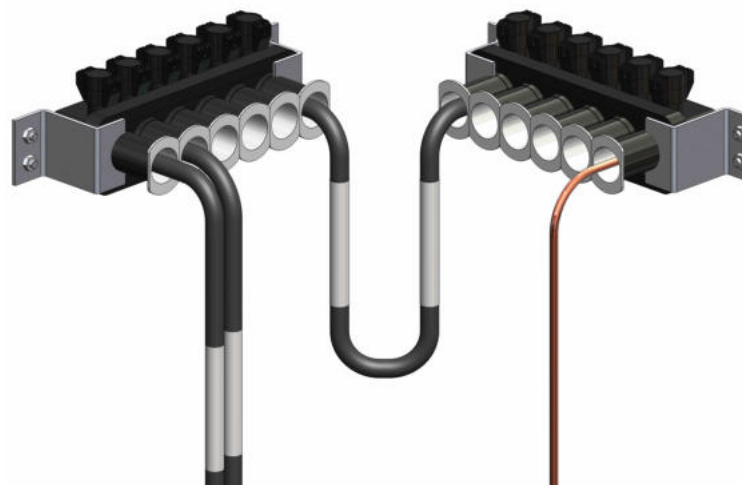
Alternativa de construcción con doble barraje en cajas de inspección.
